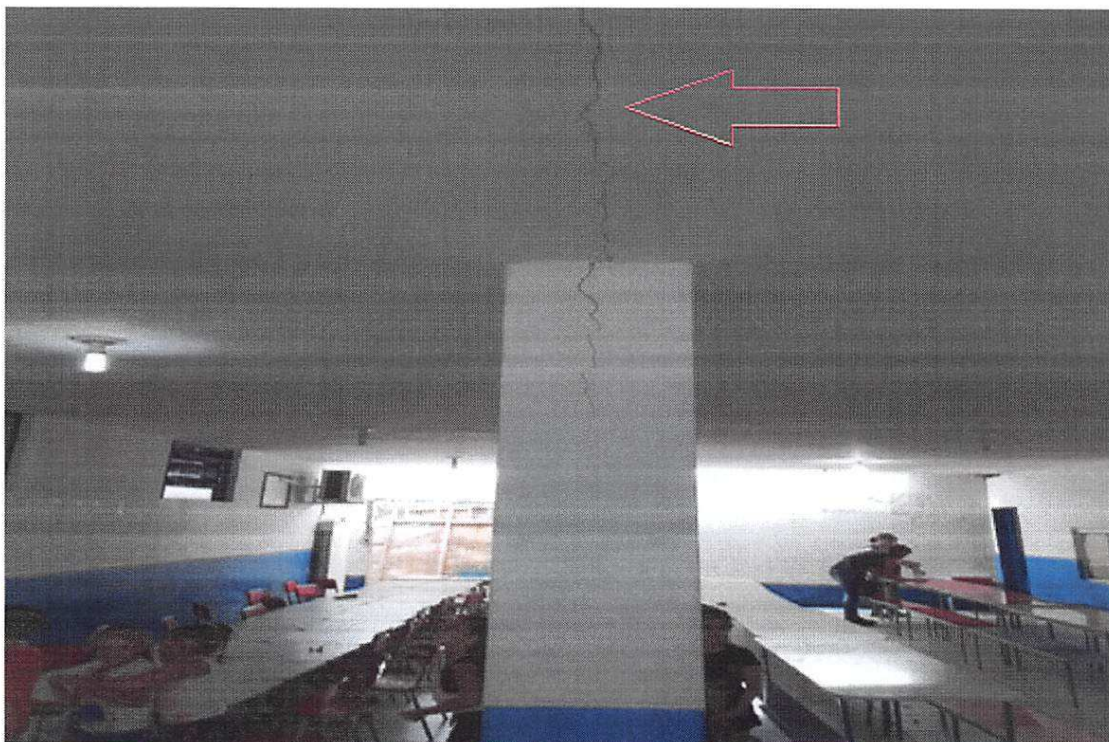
Rachaduras em pilares com exposição de armadura.
